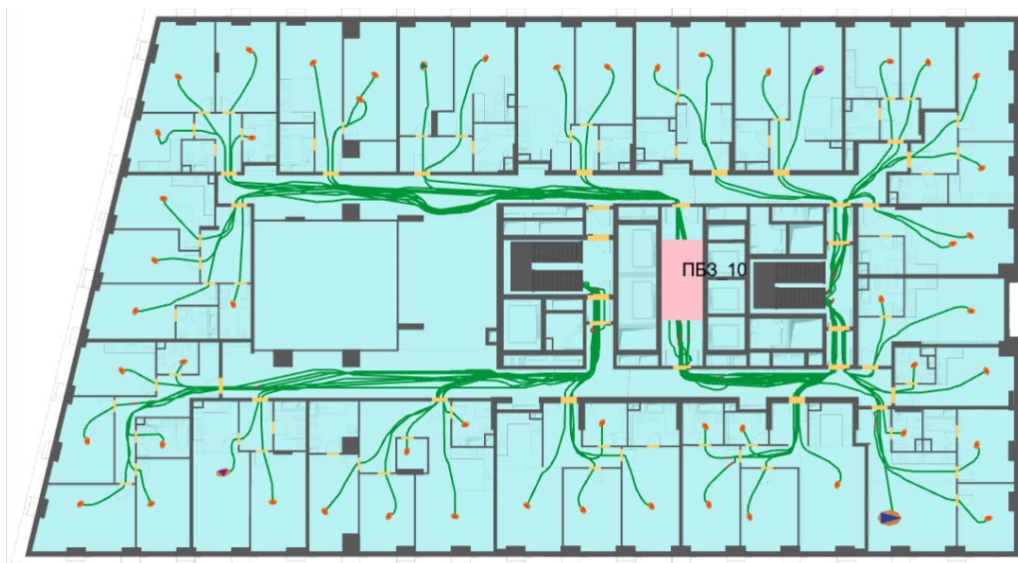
План 10-го – 13-го этажа и нанесенная на него расчетная (принципиальная) схема эвакуации
